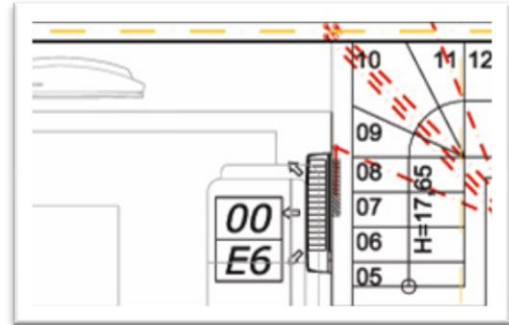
Planta baixa com localização do aparelho em parede de baixa altura.
